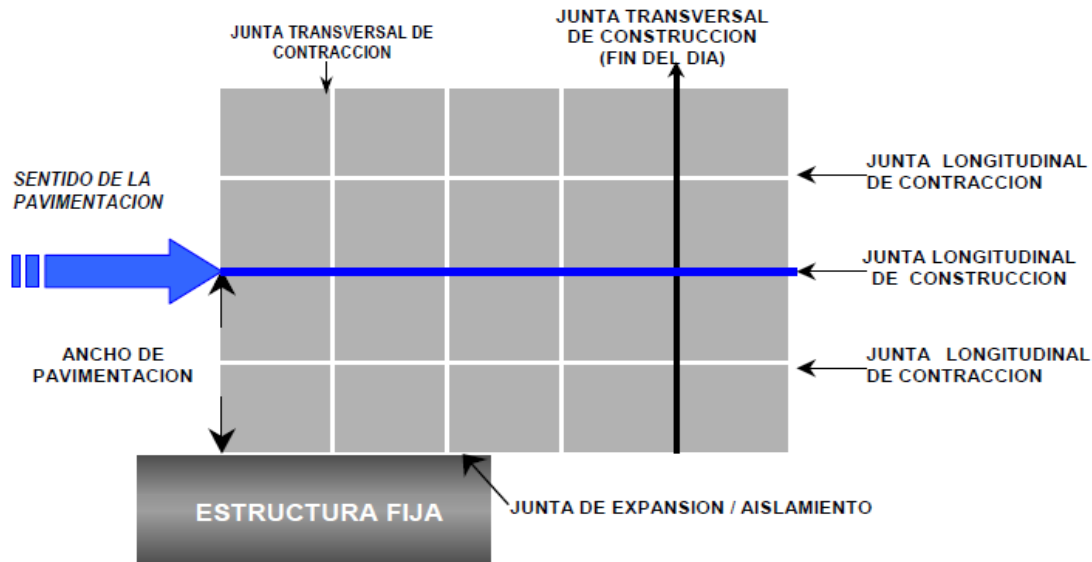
Croquis de los tipos de juntas en un pavimento de concreto.
